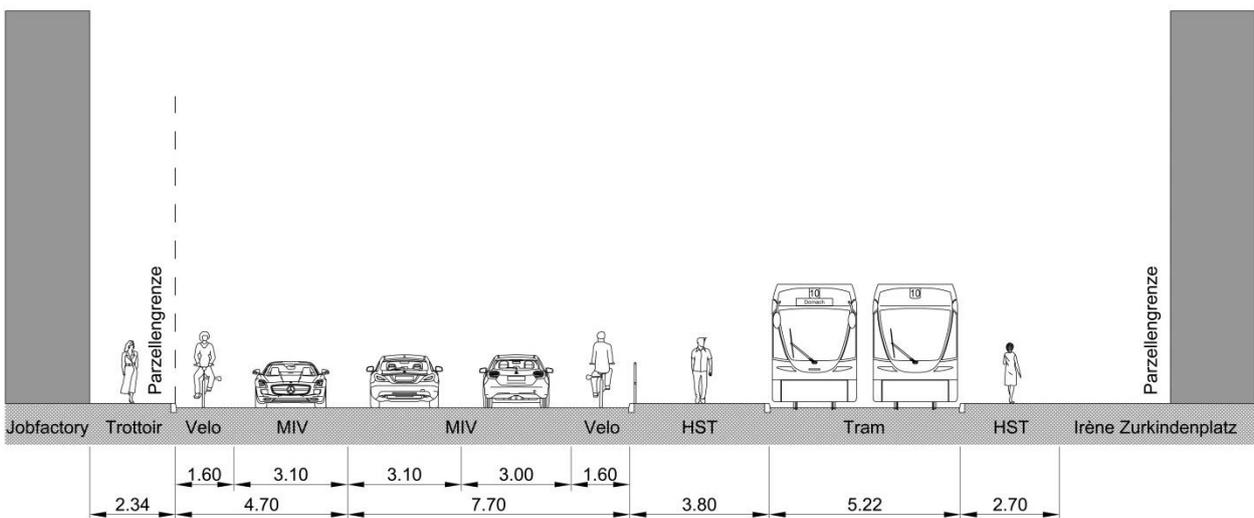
Querprofil C-C im Abschnitt Walkeweg bis Dornacherstrasse (Projekt)
